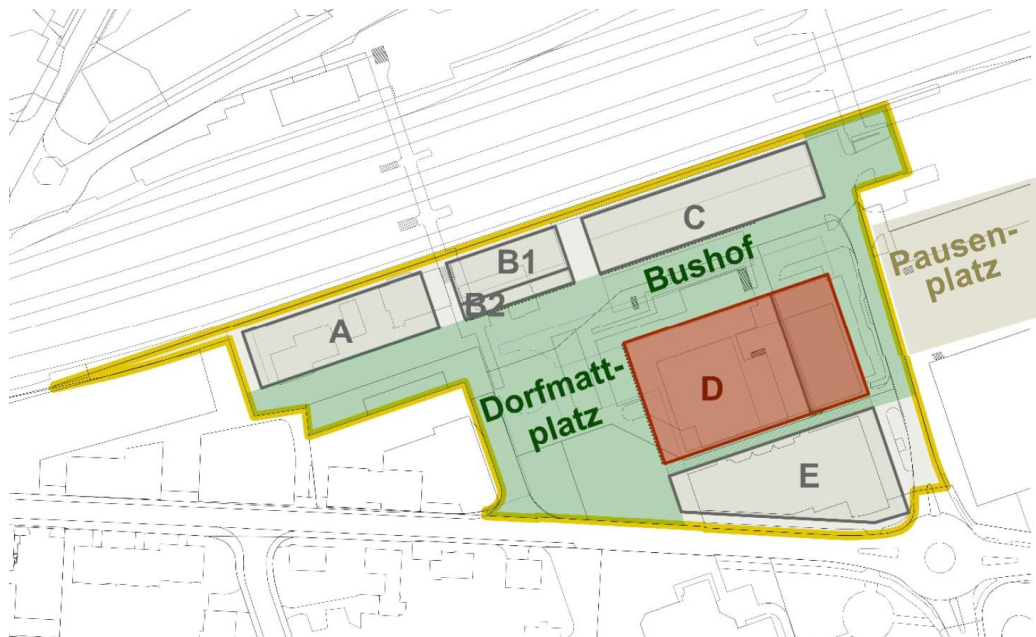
Planungsperimeter ist rot markiert mit Baufeldern D des Bebauungsplanes Bahnhof Süd. Planungsperimeter für den Aussenraum ist die grün markierte Fläche mit dem Dorfmatteplatz und dem Bushof
